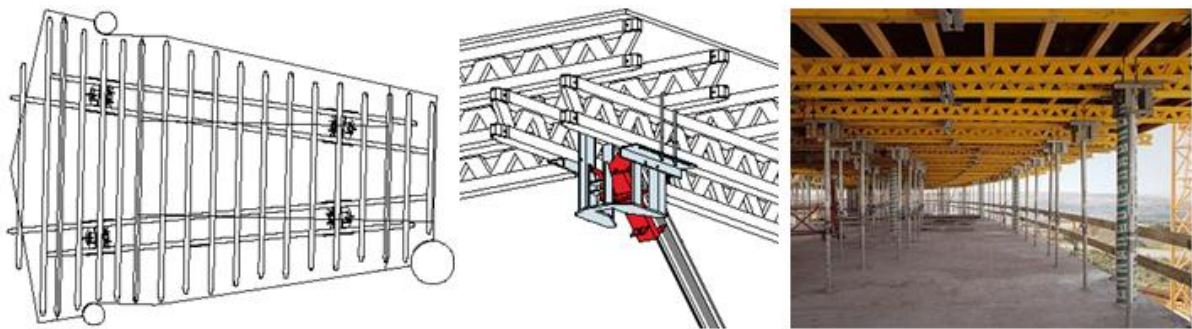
Forma trapezoidal, cabeçal que dobra numa direcção e grandes espaços entre vigas (PERI s.d.).
